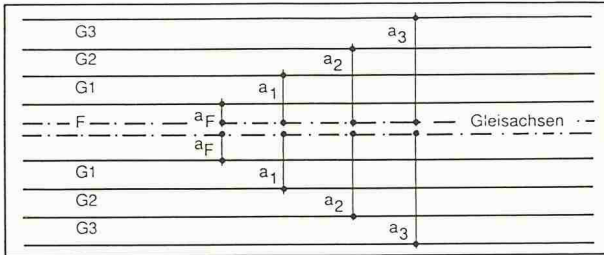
Zonengrenzen parallel zum Gleis auf offener Strecke
